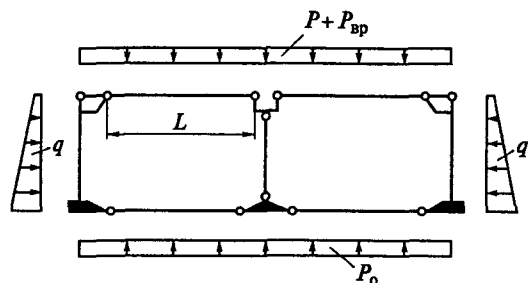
Схема расчета сборных обделок прямоугольного очертания
